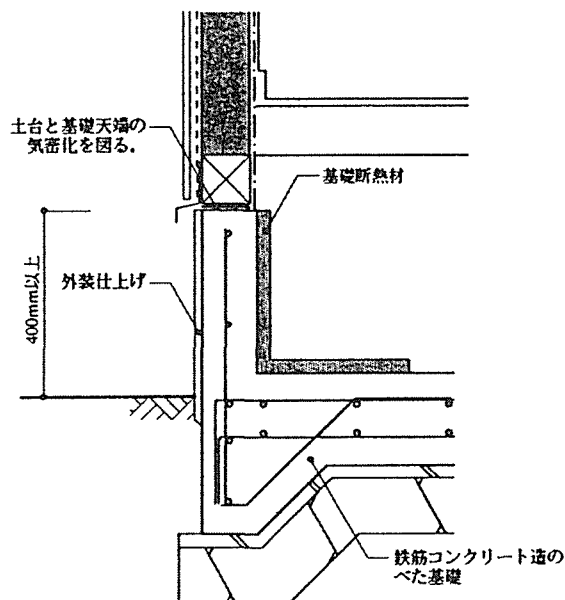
基礎断熱構法の仕様例 (内側施工+べた基礎仕様)
